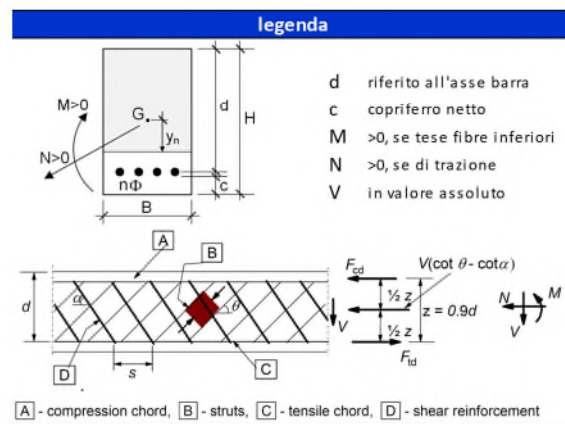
Verifica strutturale SLU - Sezione 6
